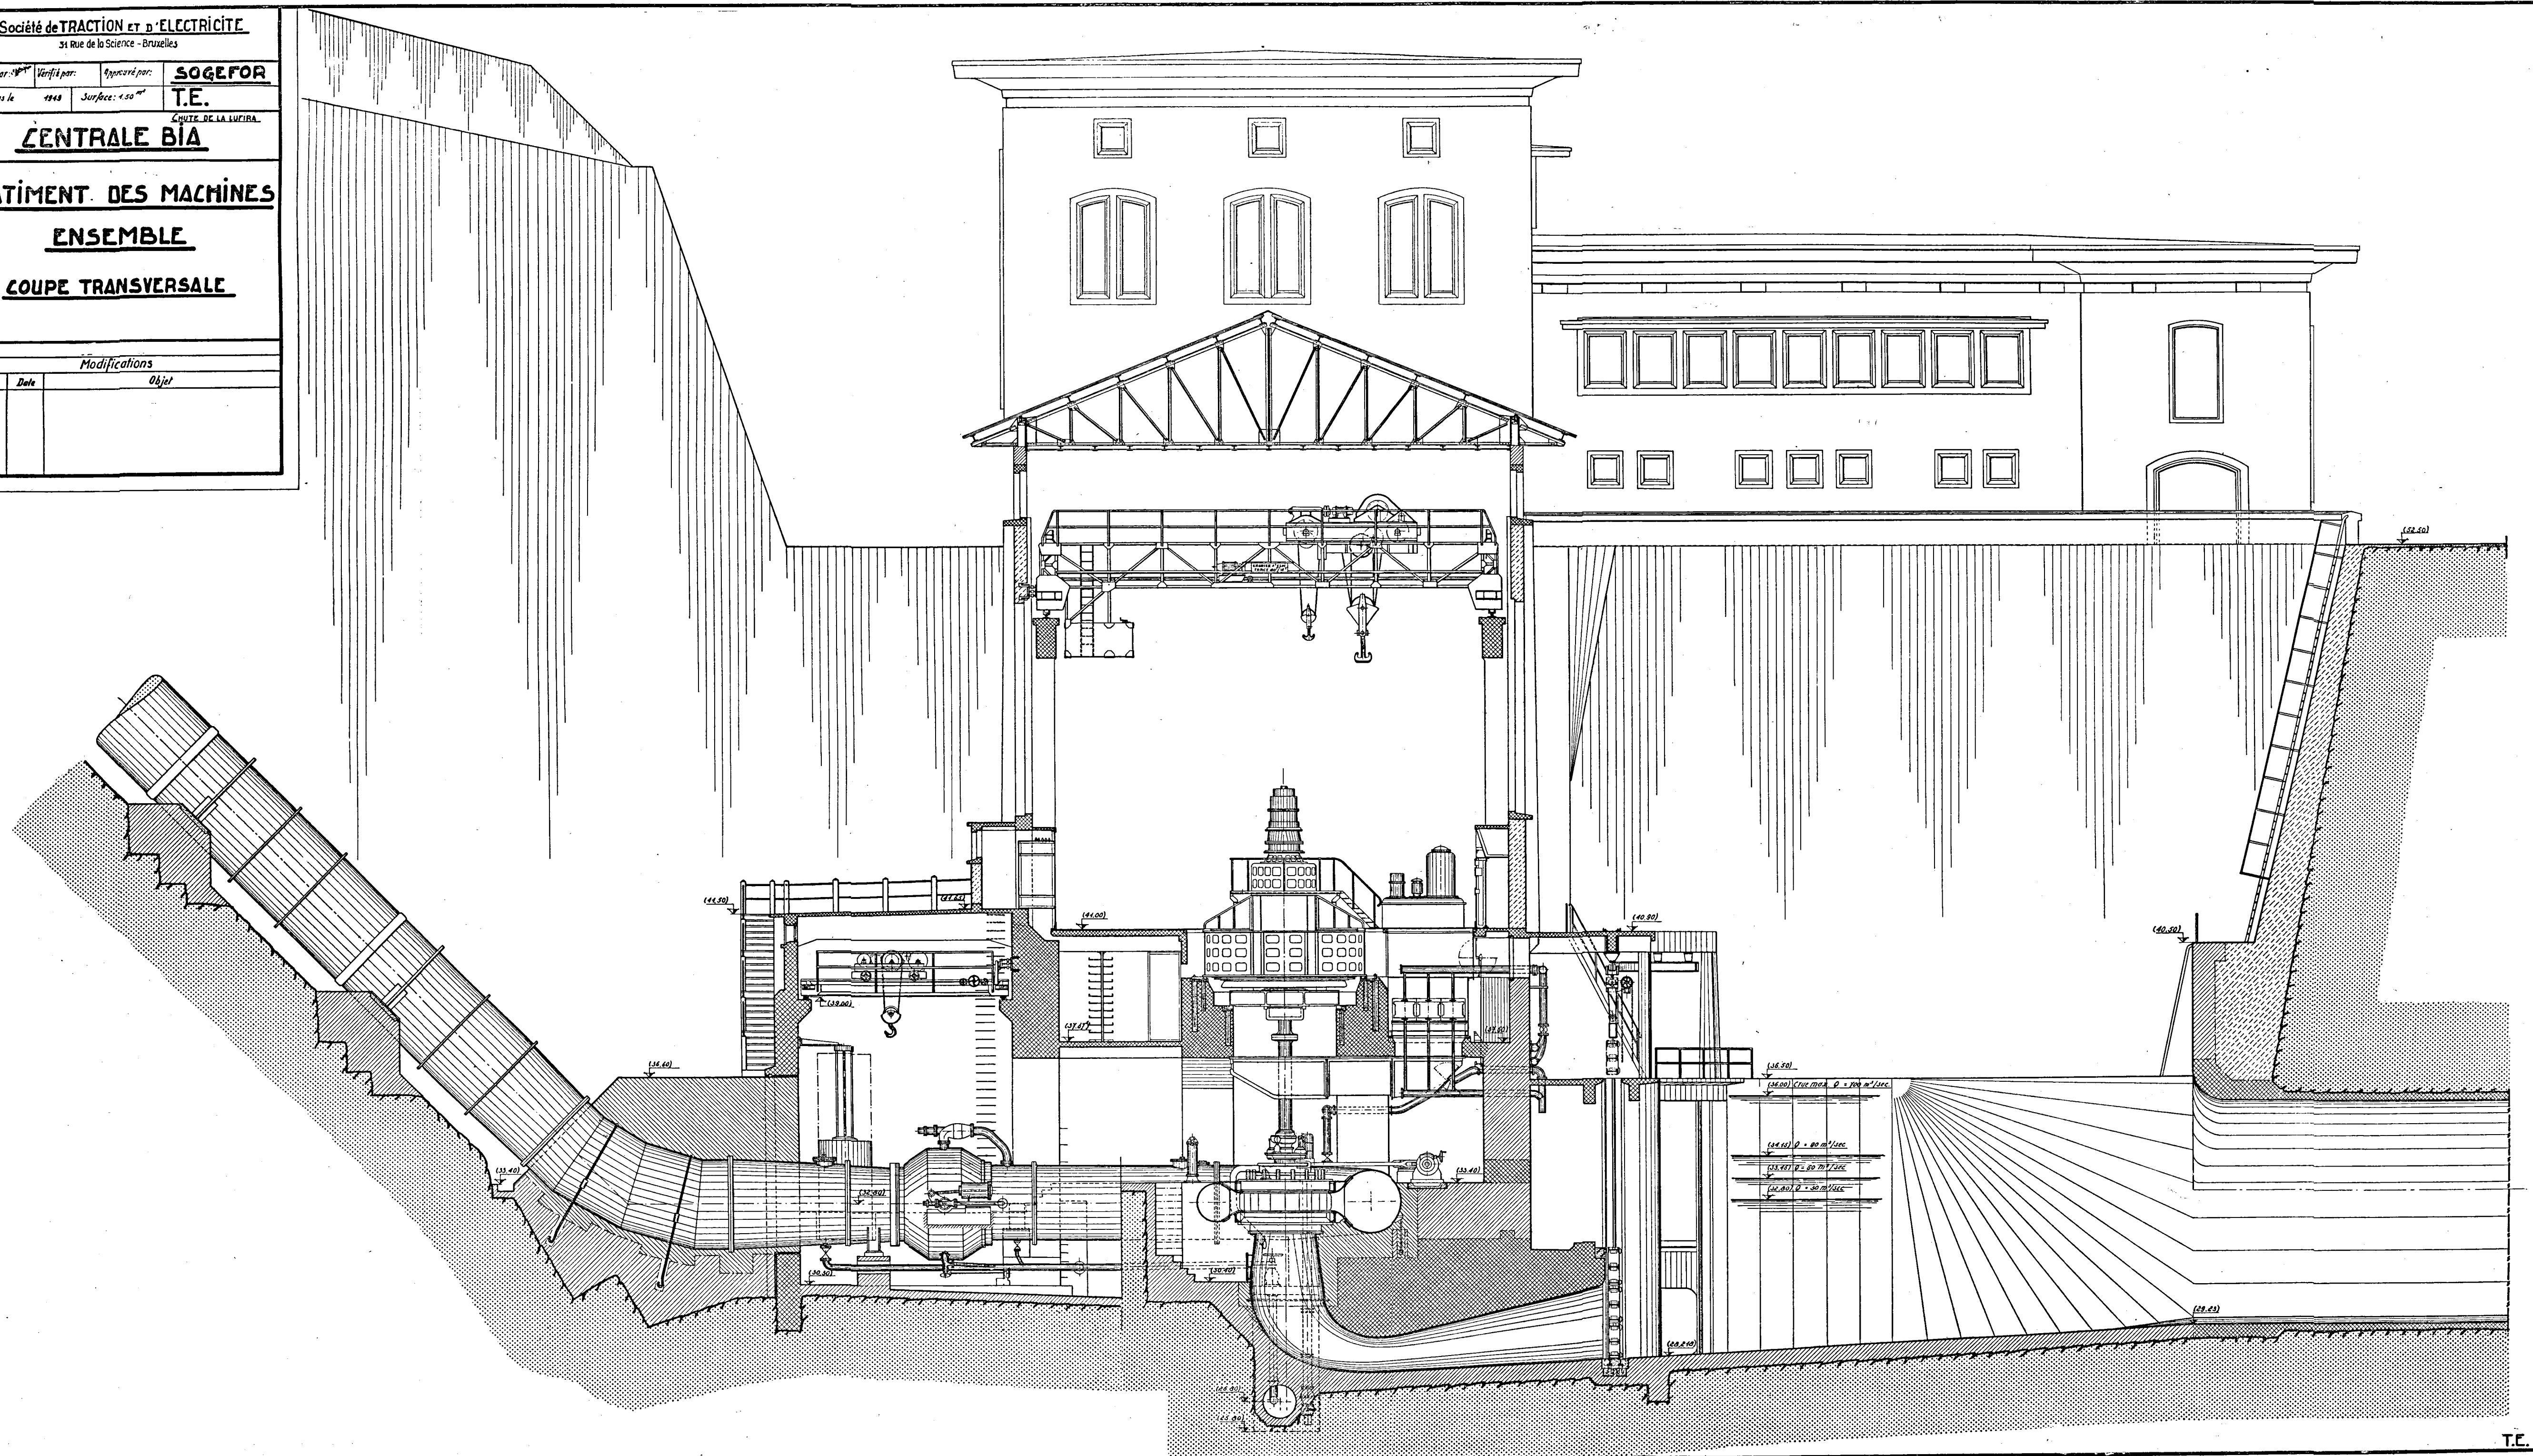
Coupe transversale de l'ensemble du bâtiment des machines.
